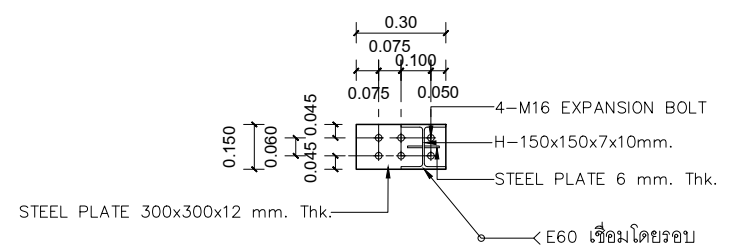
DETAIL (โครงสร้างใต้เหล็กชั้นบน)
